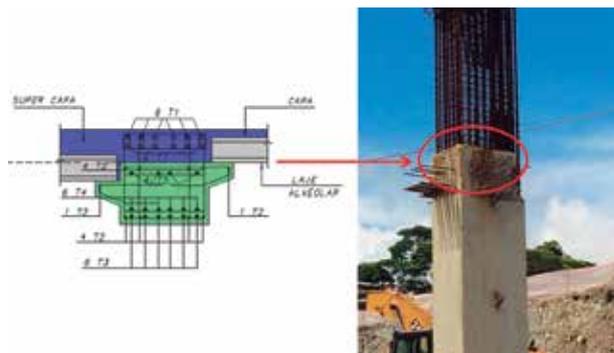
Corte e detalhe da aplicação das luvas em um dos pilares do primeiro subsolo
